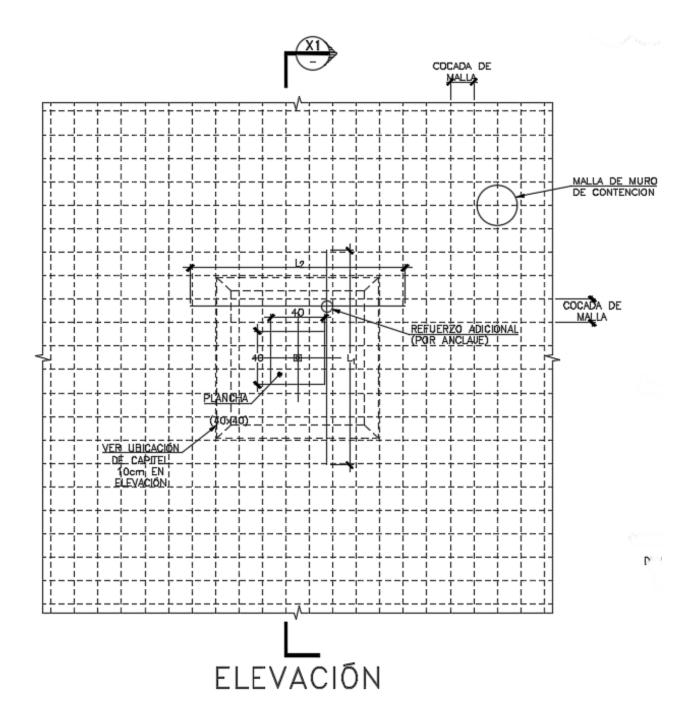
Detalle de refuerzo adicional en zona alrededor del anclaje
